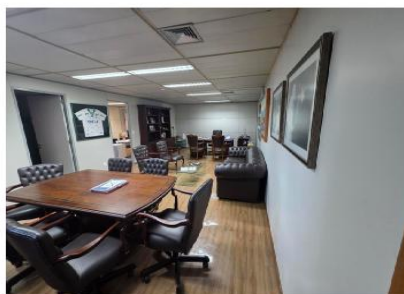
Vista geral do Gabinete - Detalhes para paredes e forro
